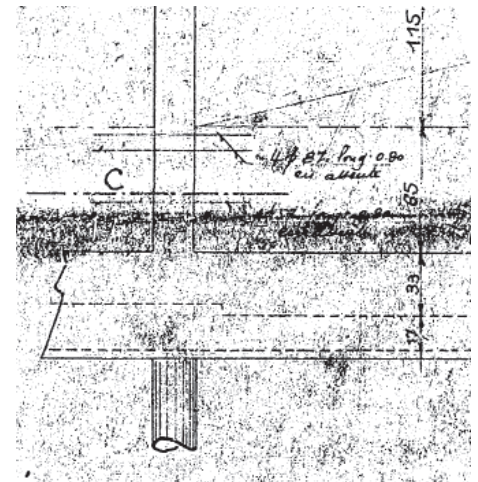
Plano del pórtico suroeste de la terraza-jardín de la Villa Savoye a escala 1:50, Cormier, 23-5-1929. FLC H1 (13) 310 (pormenor 2)
